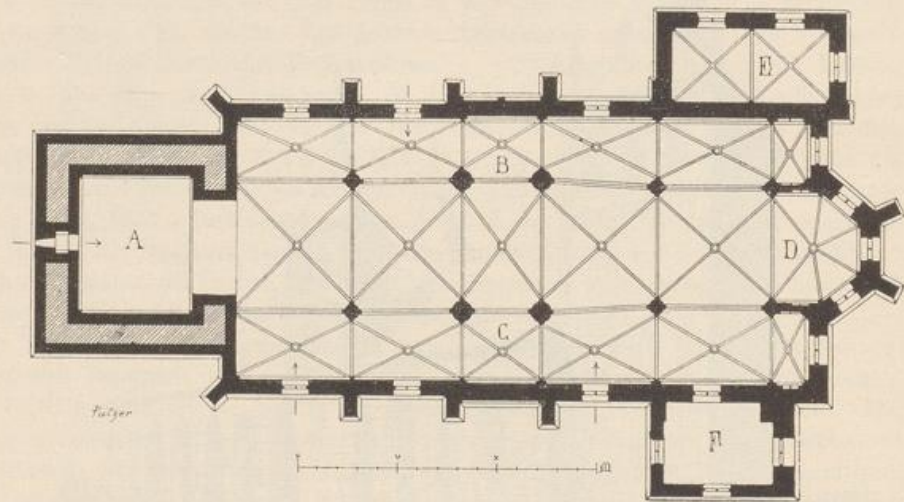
Ratingen. Grundriss der katholischen Pfarrkirche.
